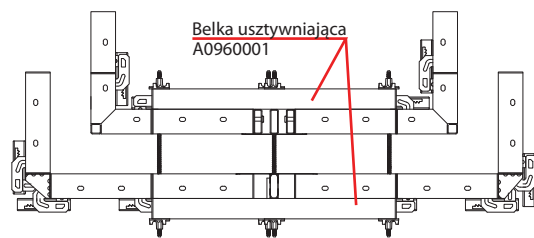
Przykład zmontowanego szalunku szybu windowego
